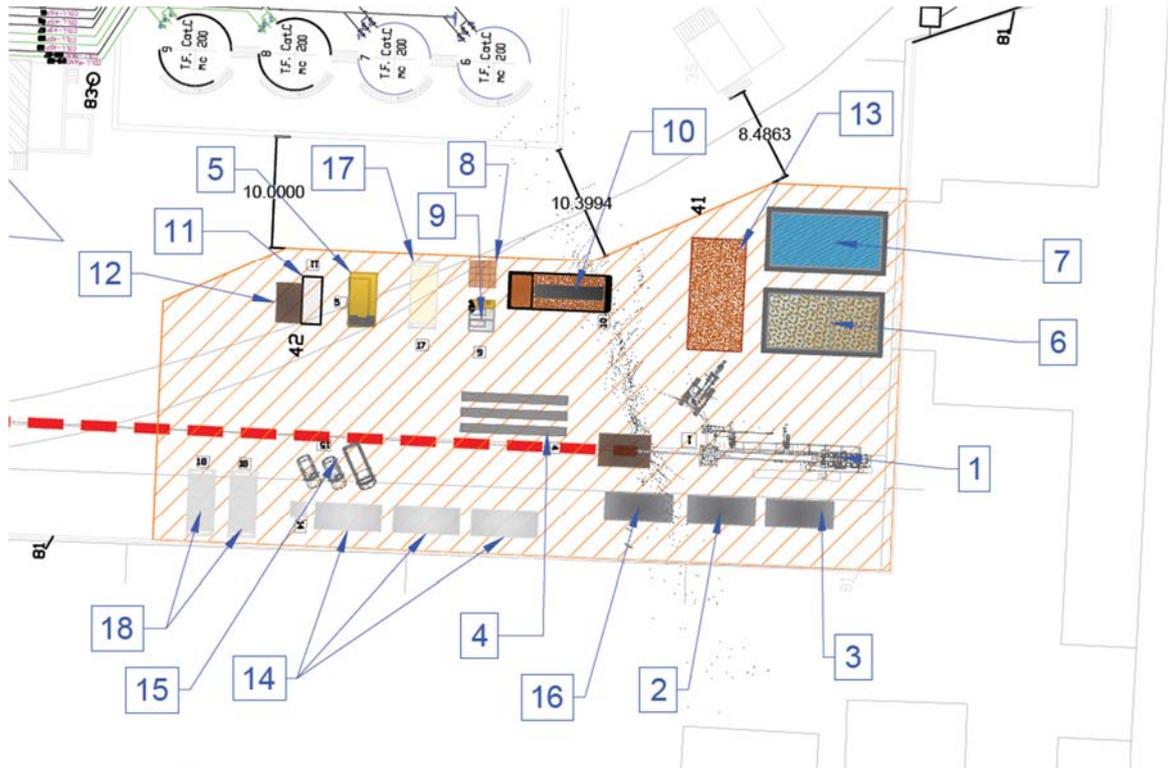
Cantiere lato Est – sistemazione delle aree – stabilimento di via Righi
